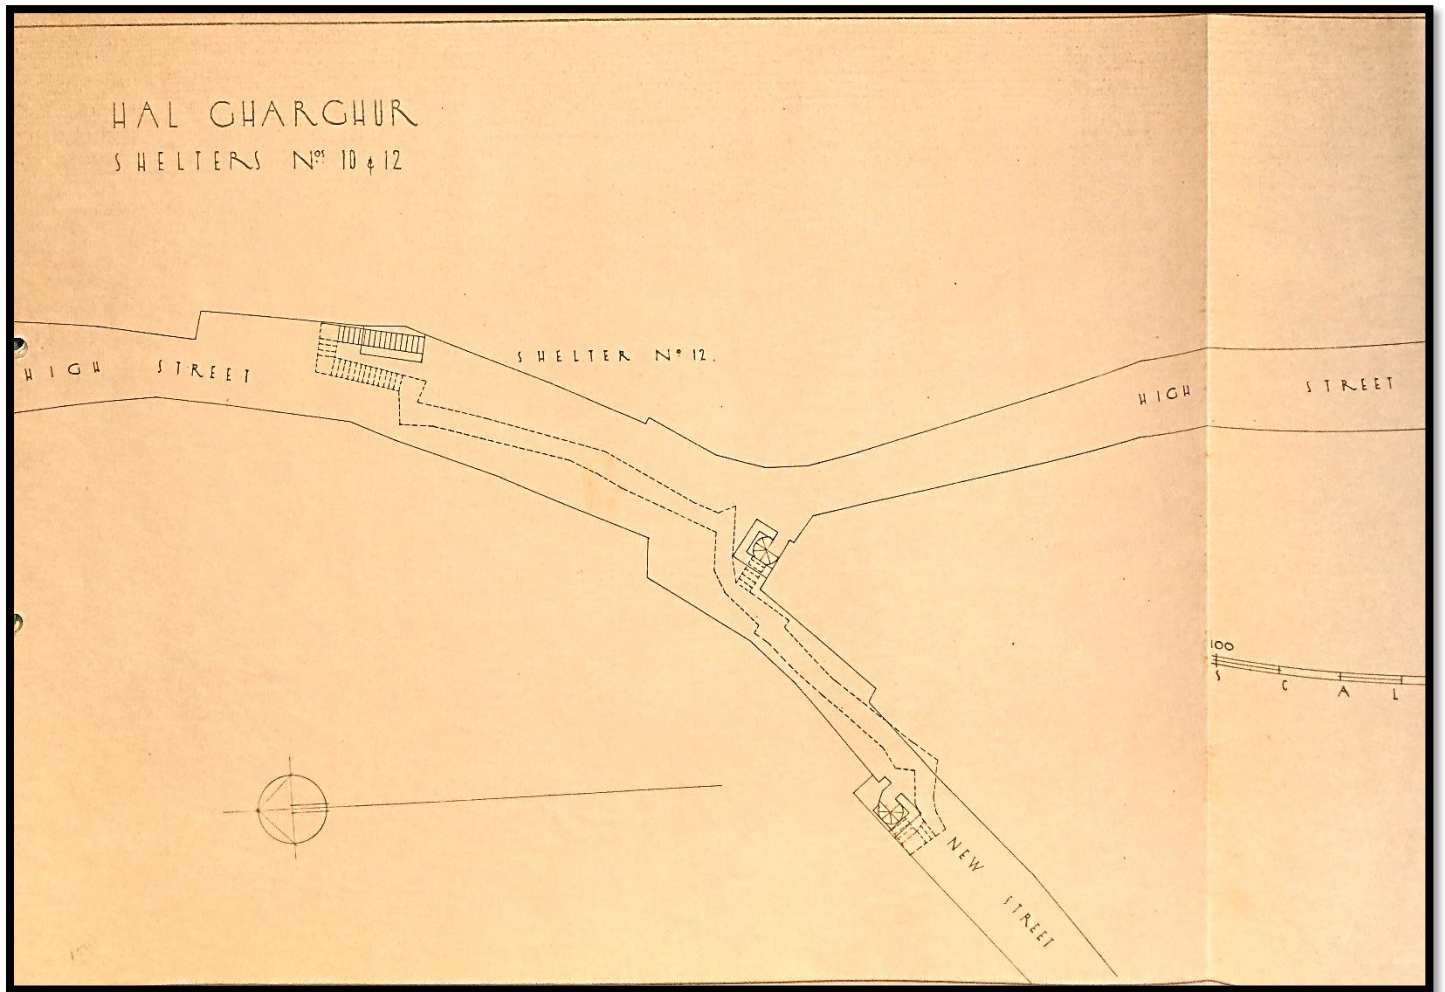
Planta do Abrigo nº10 e 12 "High Street – New Street."
